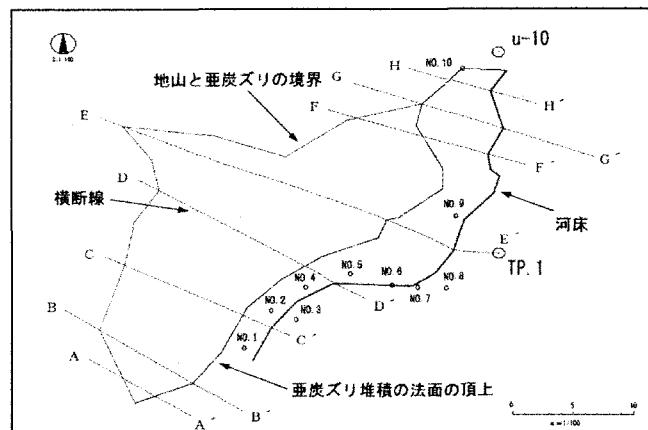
大深沢最上流部亜炭ズリ堆積現況平面図
